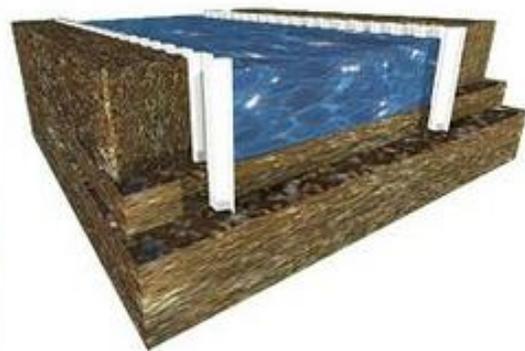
Concepto de muro de contención con tablestacas de hormigón
